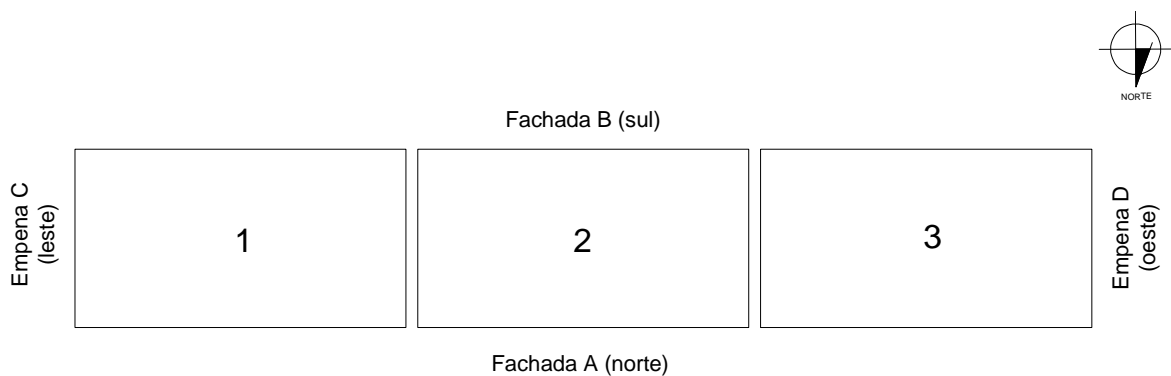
Ilustração esquemática da orientação das fachadas do edifício C.
